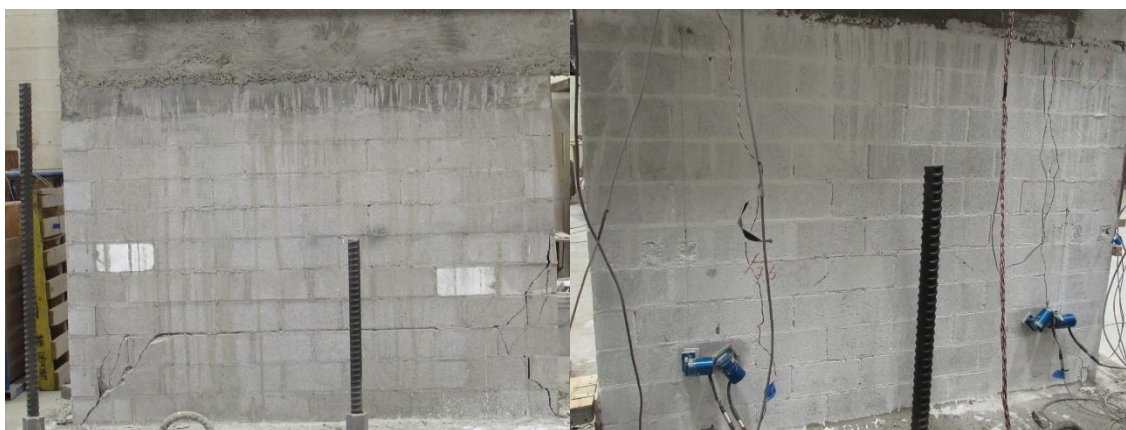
Forma de ruptura da parede 9 dotada de abertura de porta e acoplada por viga de concreto armado
